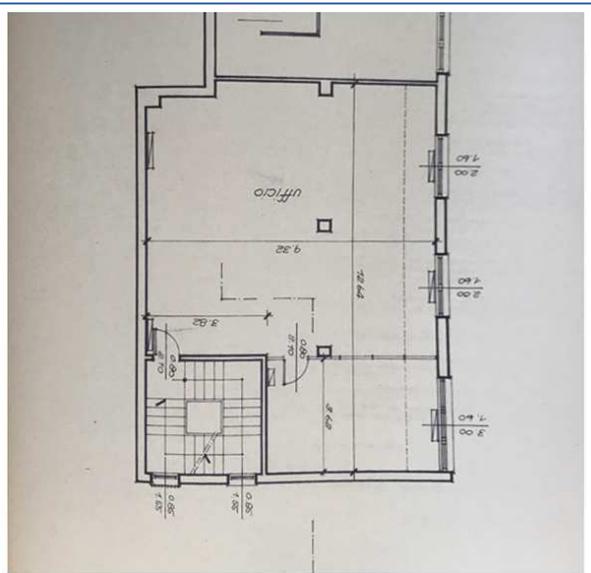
estratto dell'ultimo titolo edilizio planimetria piano 1
